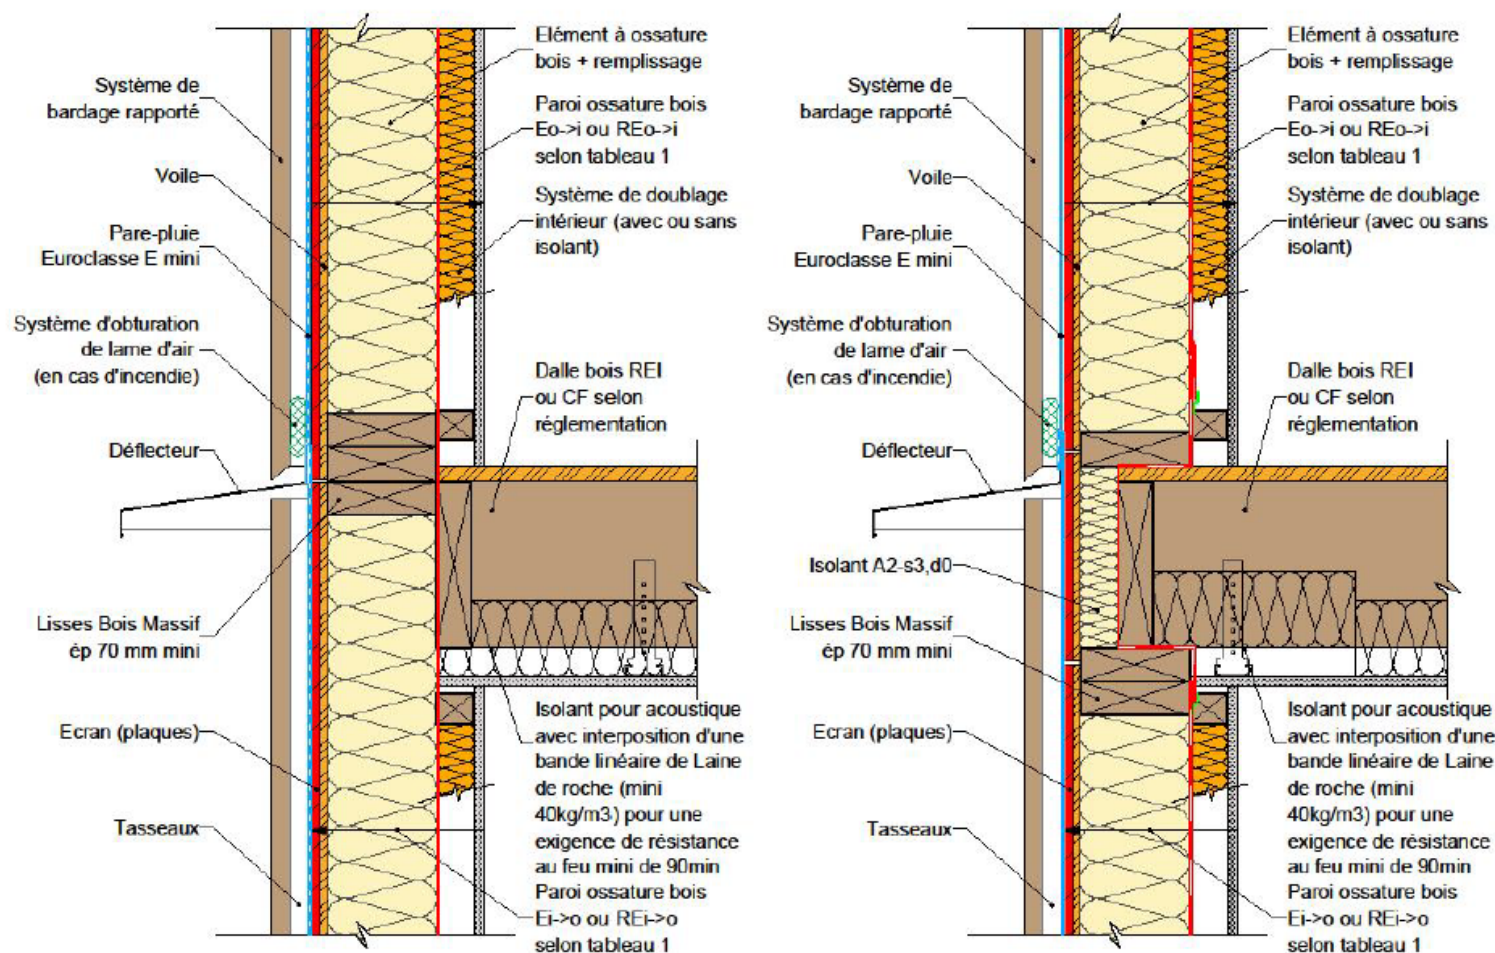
Façade/mur ossature bois & plancher en ossature bois.
